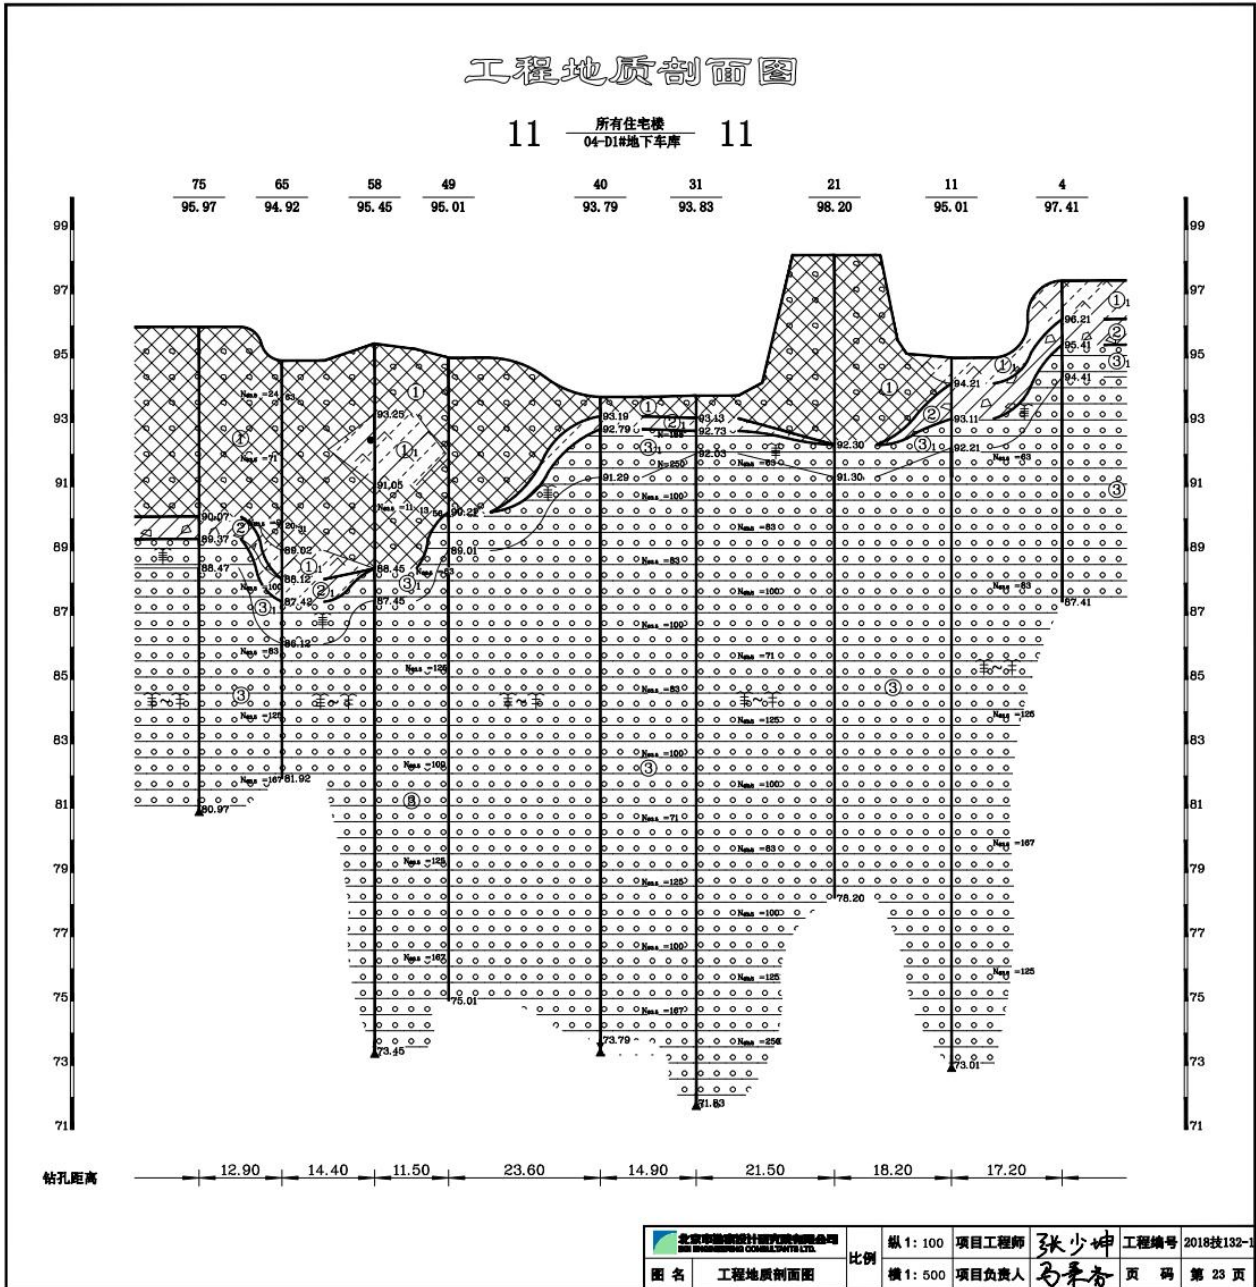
A-04 地块 11-11' 工程地质剖面图
